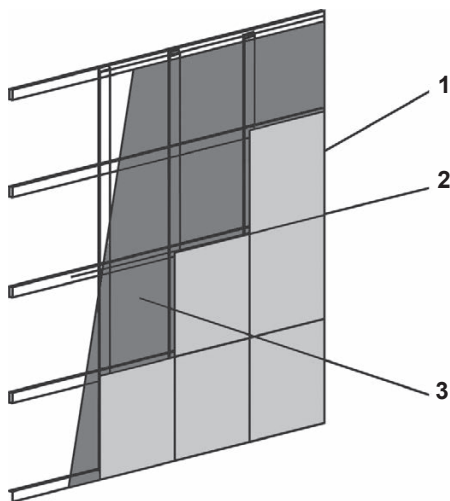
Утепление стены изнутри: 1 — теплоизоляционный слой; 2 — деревянная обрешетка; 3 — гипсокартон
